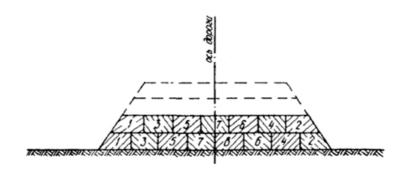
Схема разгрузки грунта и укладки его в насыпь:
